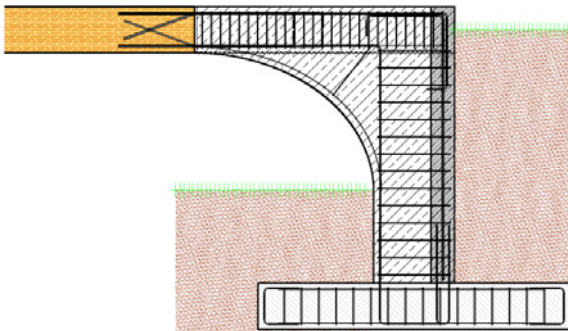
Schnittskizze des integralen Widerlagers mit monolithischem BSH-Stahlbetonanschluss (Bewehrung im Stahlbeton schematisch)
